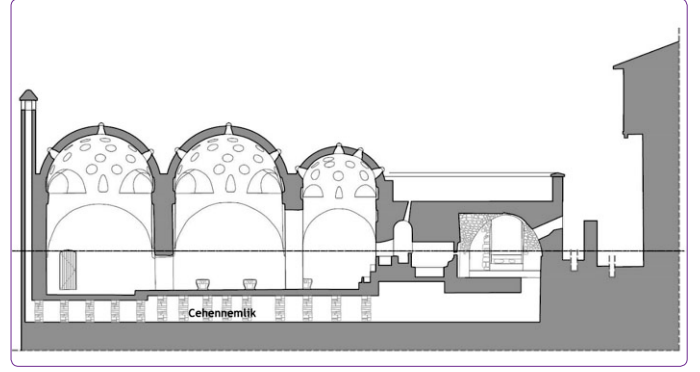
Antakya'da yer alan Yeni Hamamın plan şeması ve cehennemlik hattı (Yerinde yapılan tespit doğrultusunda hazırlanmıştır, 2016).
